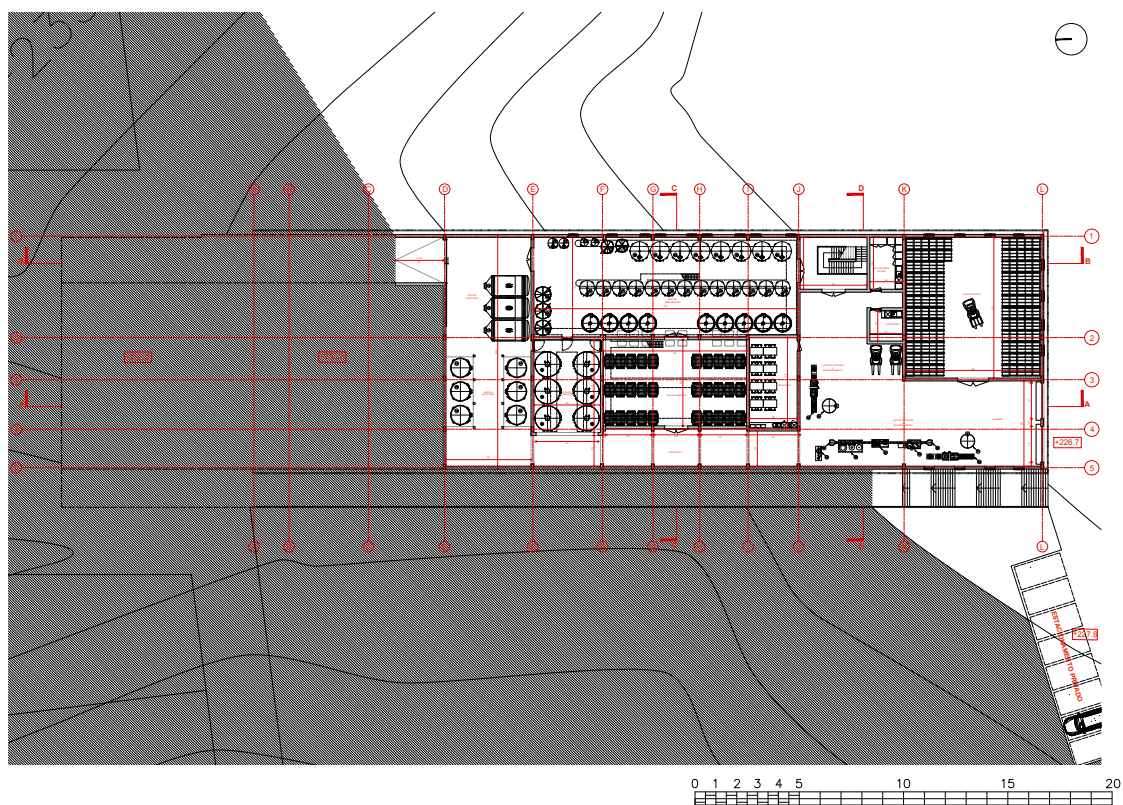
Planta do Piso Térreo Proposta Esc.1:200
